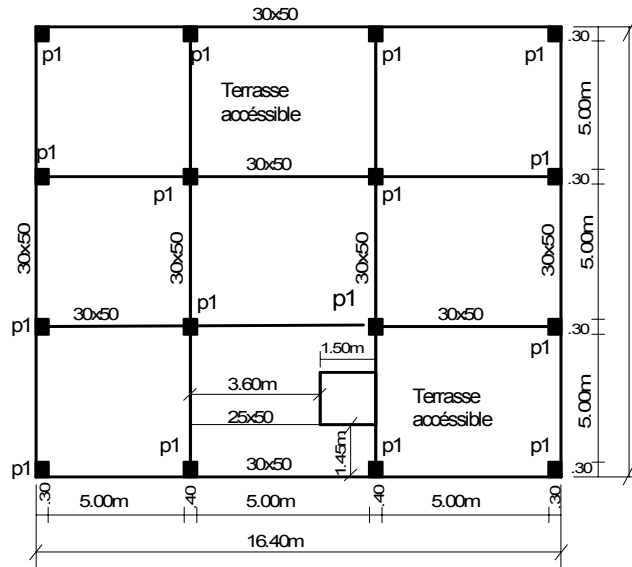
d : vue en plan du 5<sup>ème</sup> niveau (terrasse)
